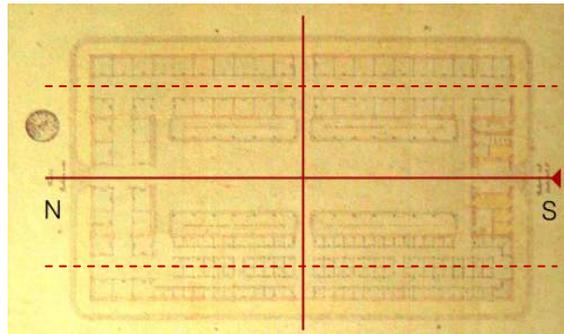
Planta esquemática: eixos estruturantes
